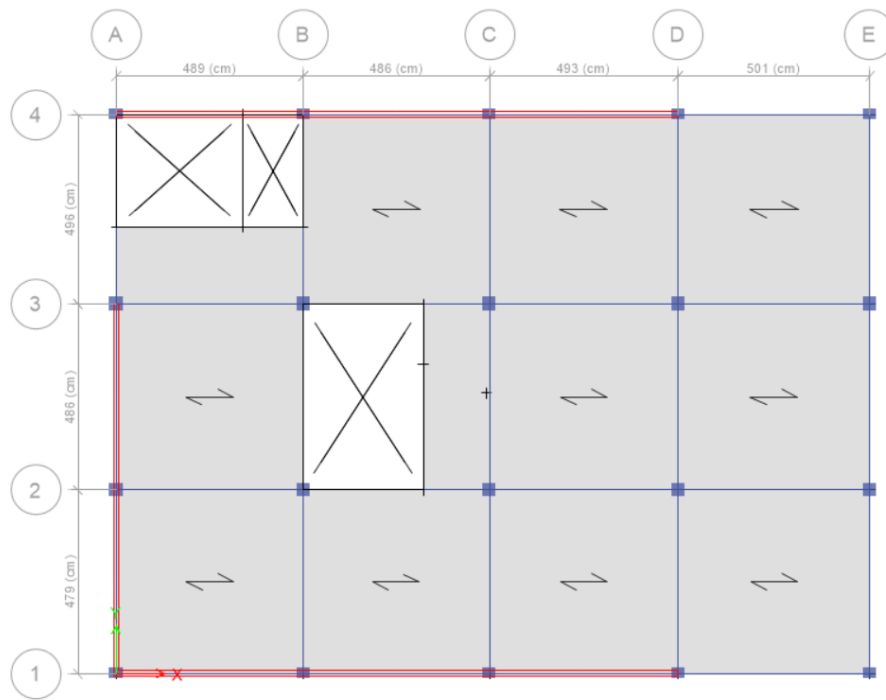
Ubicación de elementos estructurales - Nivel 01
